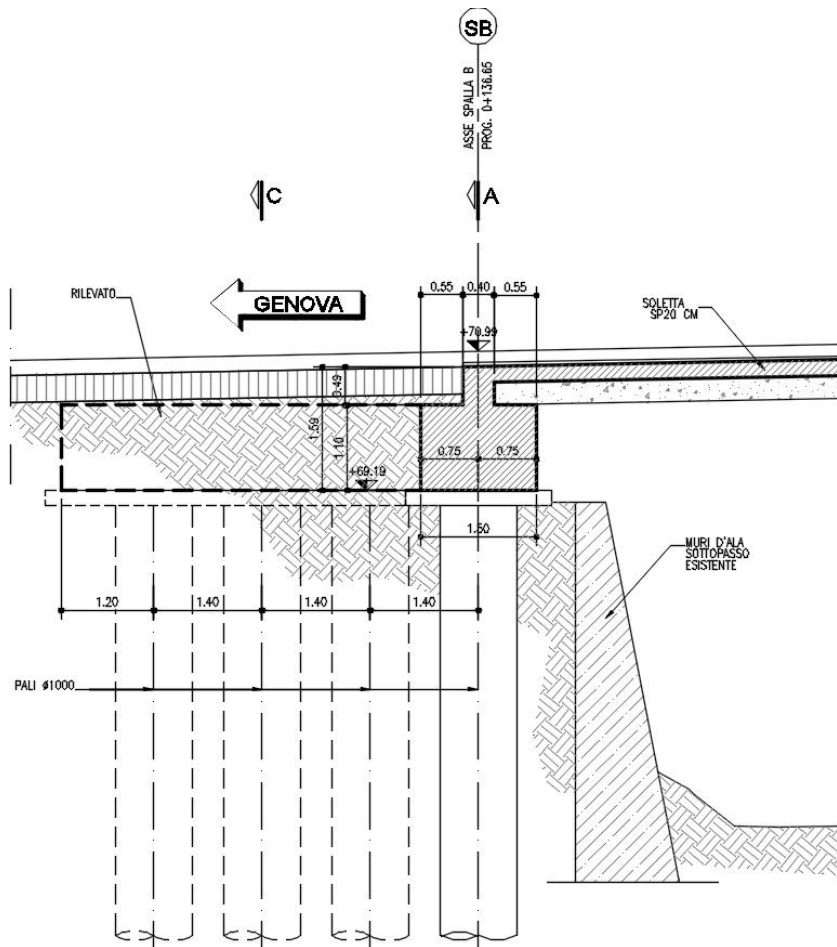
Spalla lato Genova - Sezione longitudinale
